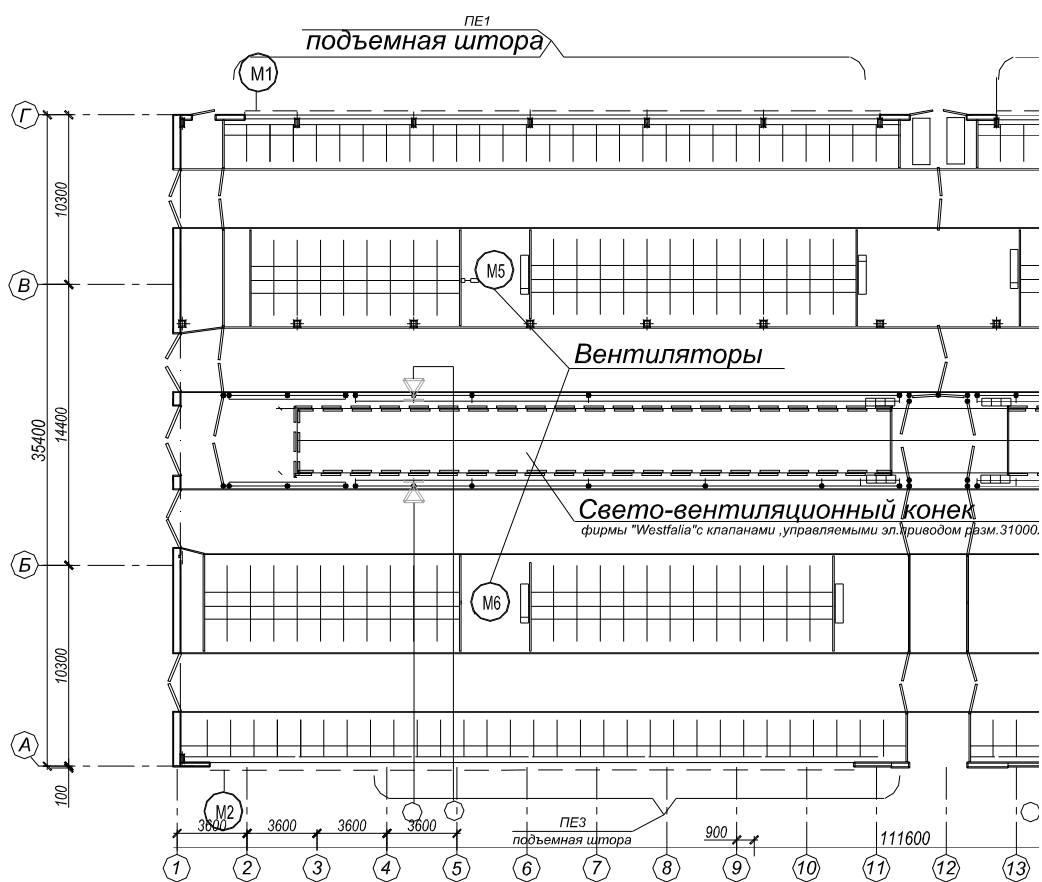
Часть здания фермы КРС с расположением вентиляционного оборудования
